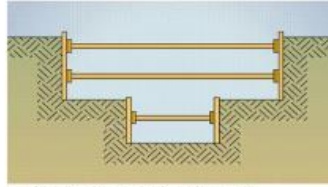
Escavação tabulada (escavação com paredes em tabuletas)
